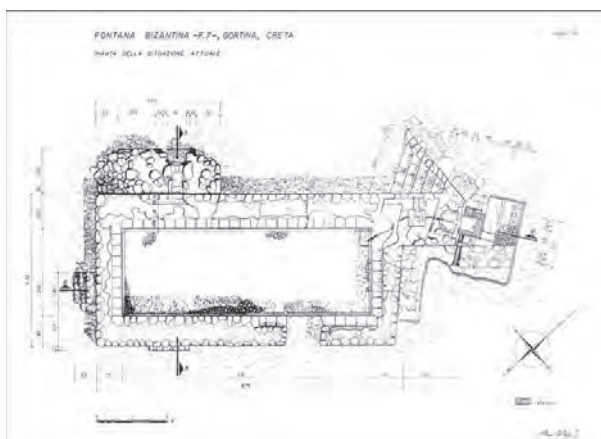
Planimetria della cisterna/fontana nr. 88 (A. Ortega 1989, Archivio SAIA).
